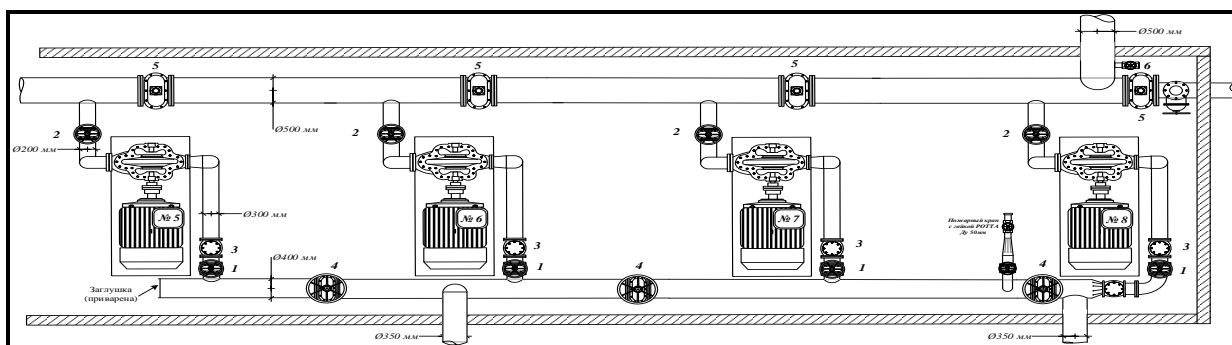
Схема размещения насосных агрегатов и трубопроводов в машинном зале здания главной водопроводной насосной станции, обеспечивающих подачу воды в первую зону водоснабжения города Петропавловск-Камчатский.
